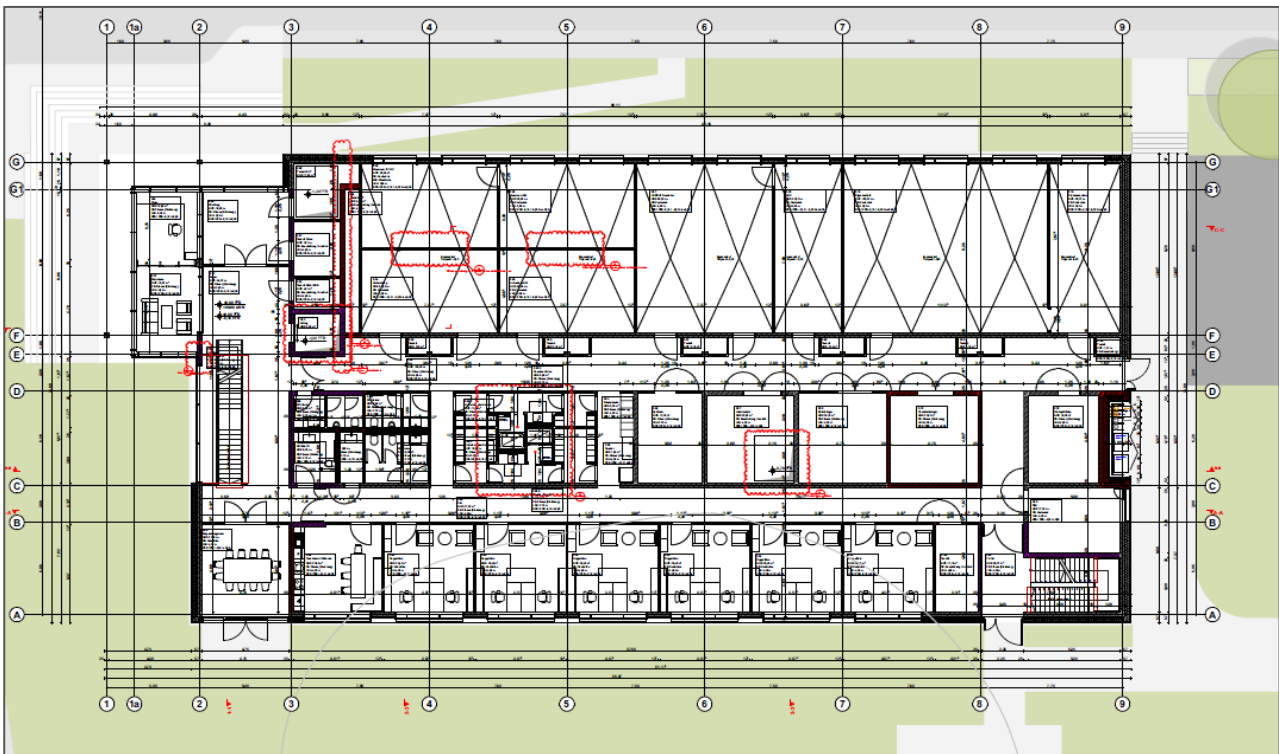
Labor- und Verwaltungsgebäude, Planauszug Grundriss Erdgeschoss
